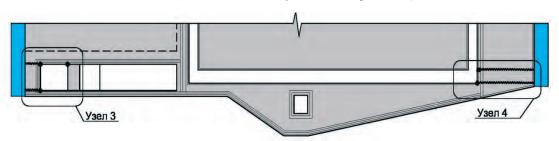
Гидроизоляция стыков в потернах, смотровых шахтах и соединительных коридорах здания ГЭС (фрагмент 2 на рис. 6.1.1)
